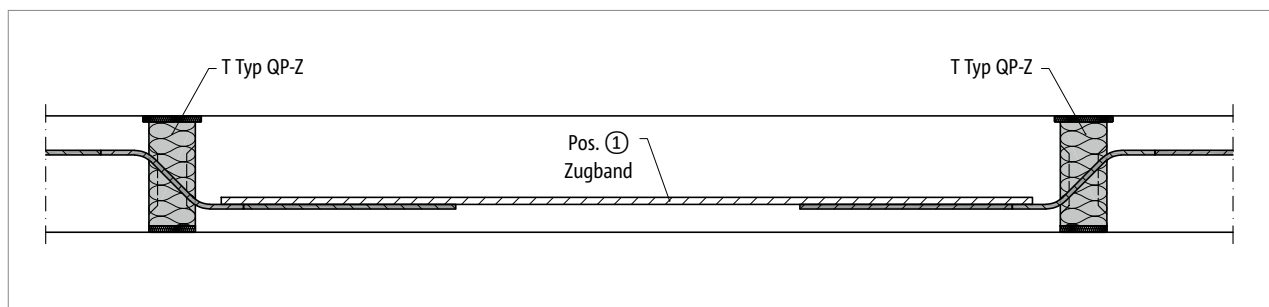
Schöck Isokorb® T Typ QP-Z: Bewehrungsanschluss Zugband
